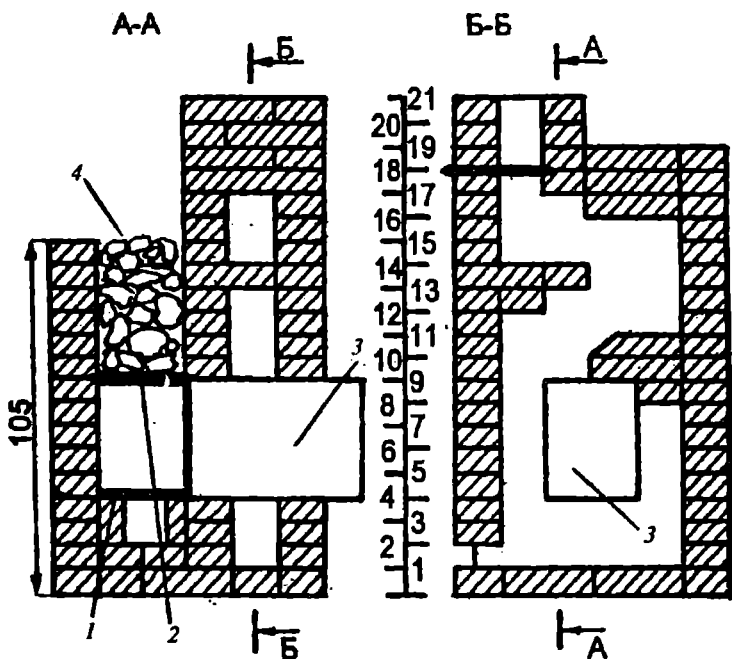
Устройство печи-каменки с нижним размещением бака:
